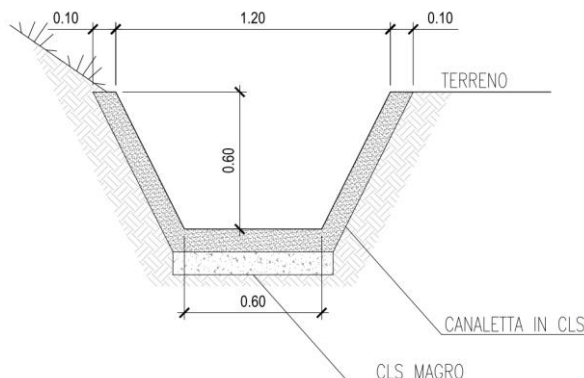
Tipologia di sezioni trapezie in calcestruzzo utilizzate – CANALETTA TIPO 2
